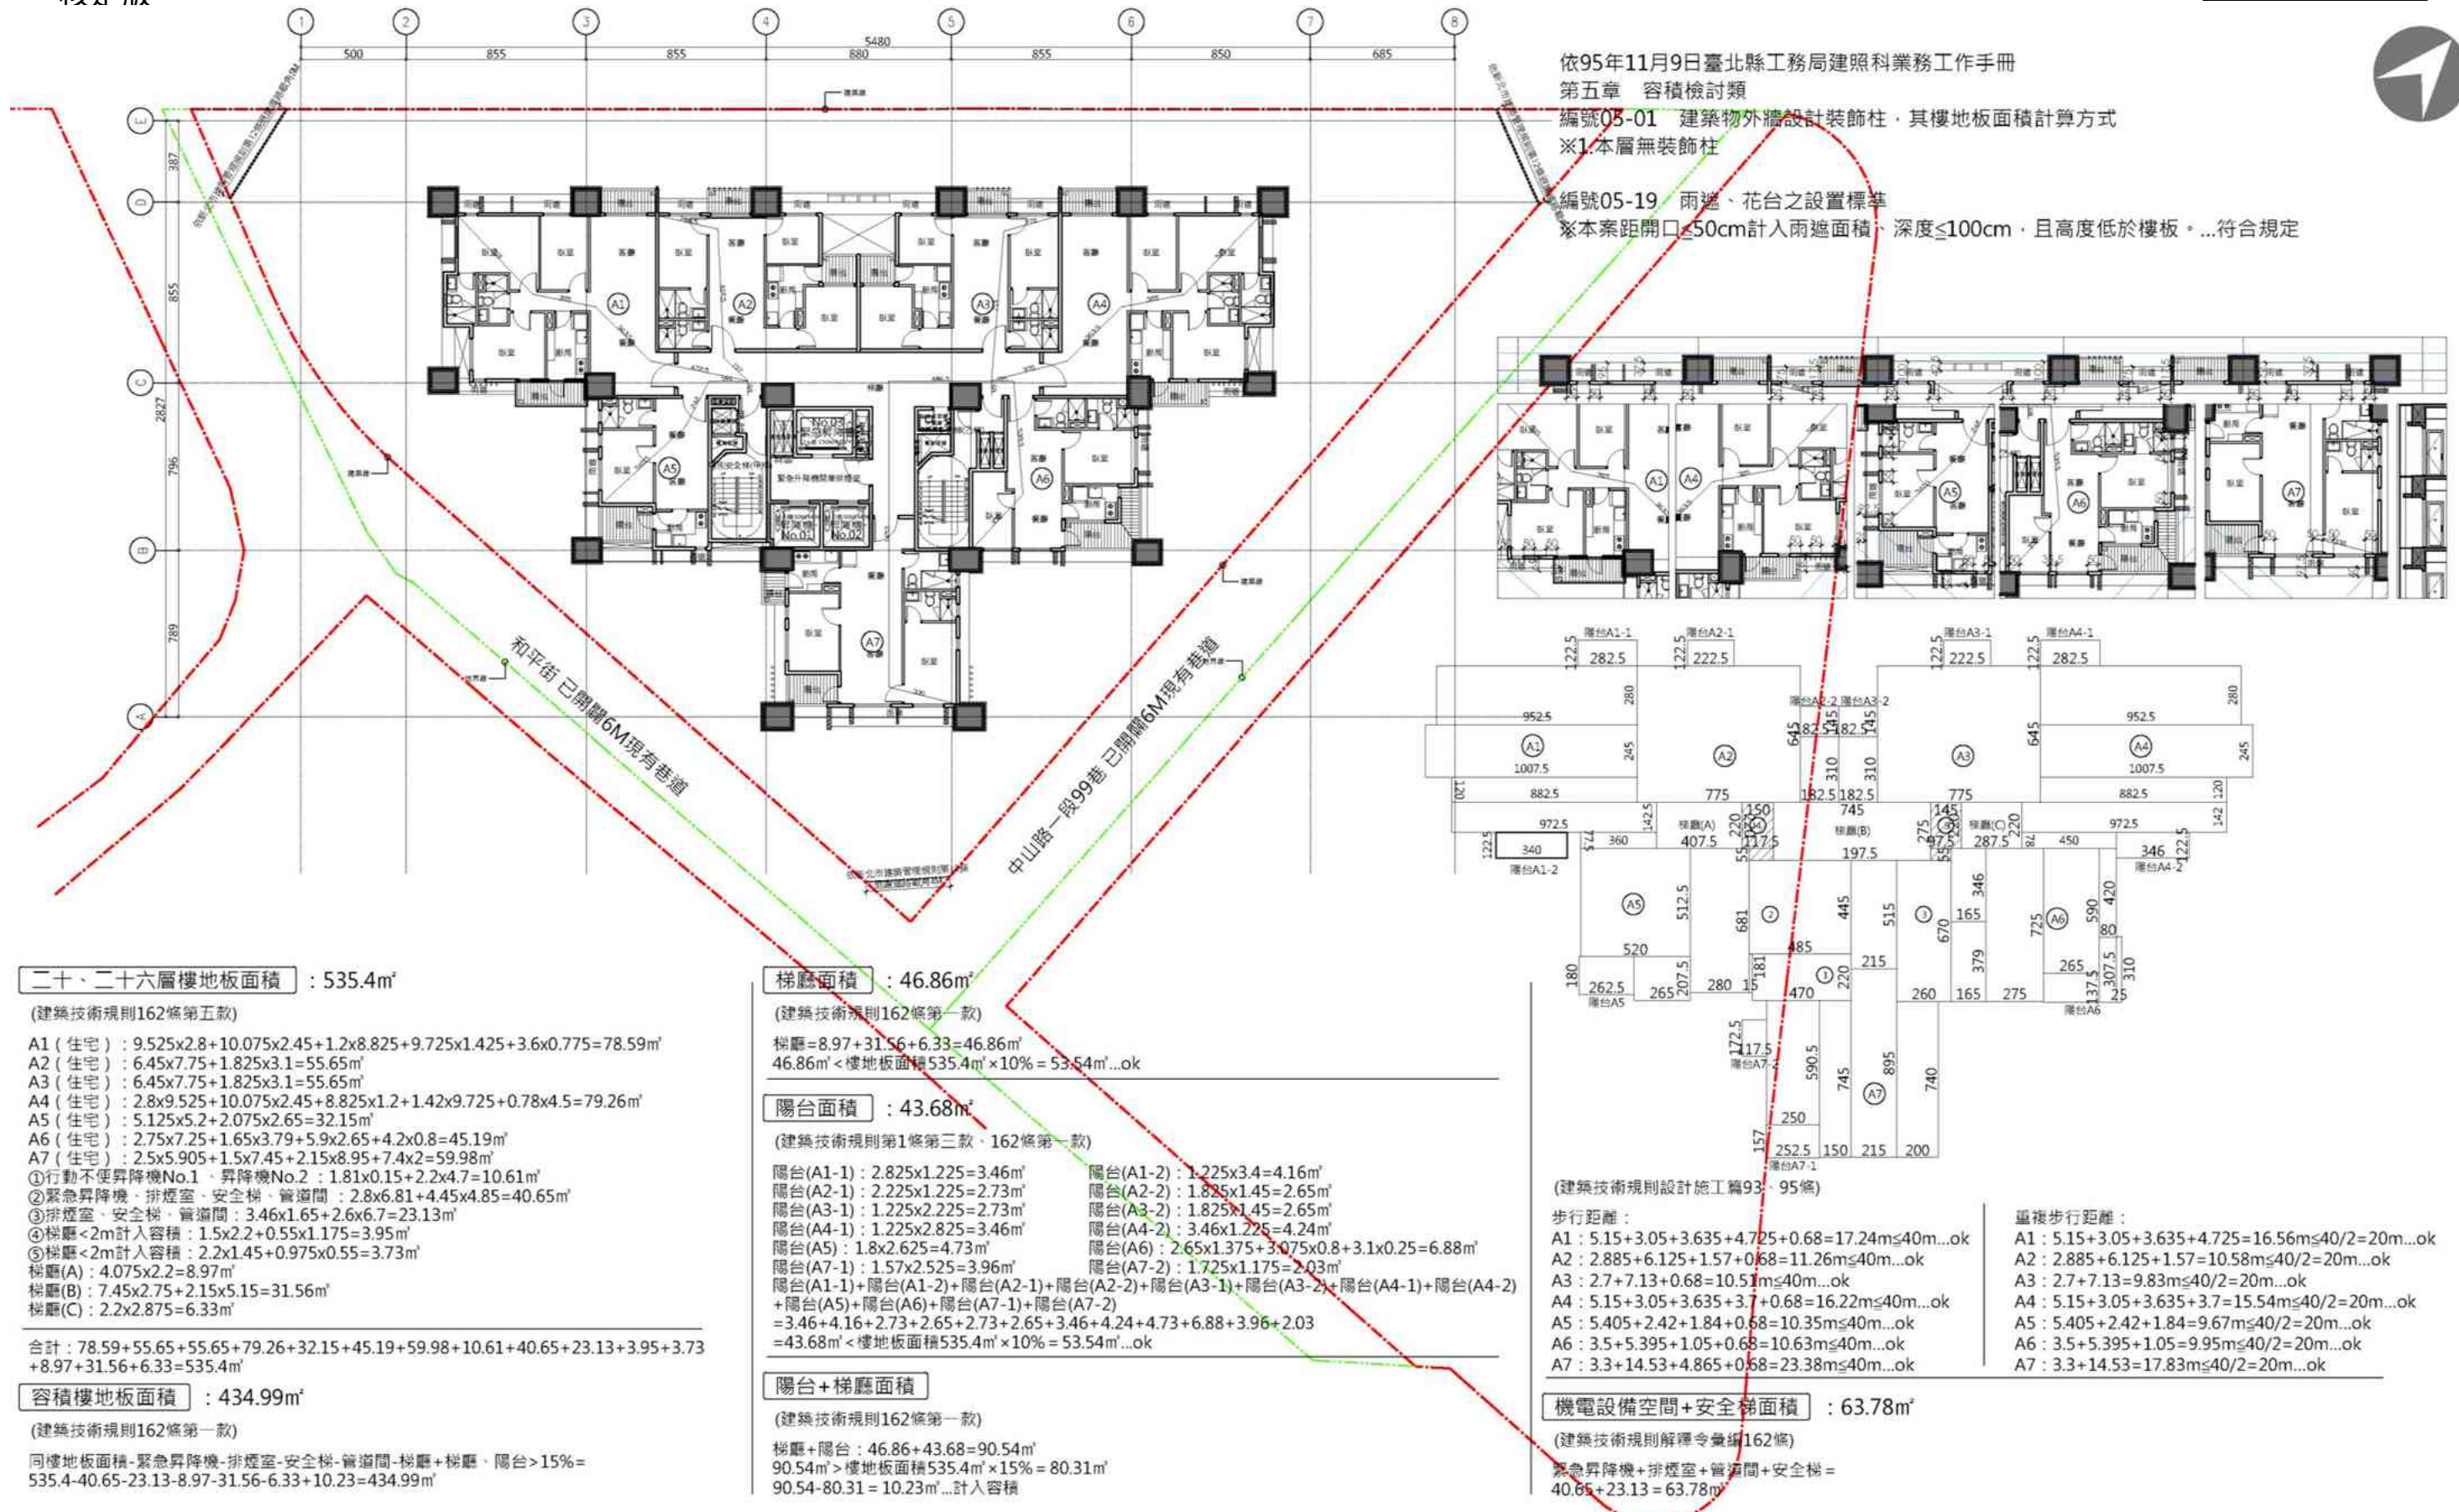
19、25F 平面圖；SCALE A3=1/300
